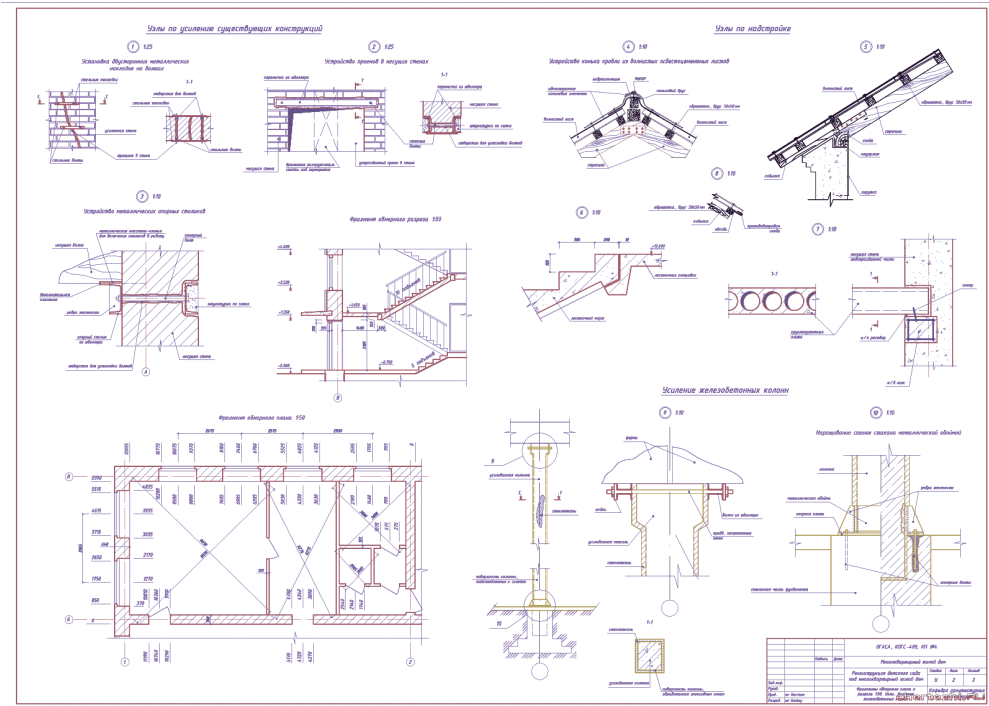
Фрагмент плана, разрез, узлы, детали
